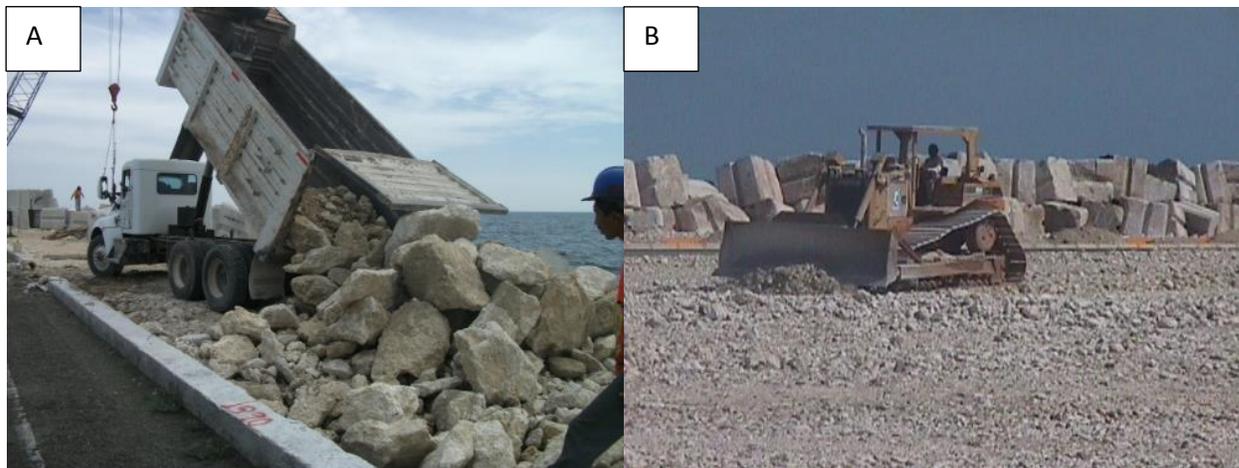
A) Ejemplo de acarreo y llegada de la piedra a la zona de trabajo y B) Se visualiza el tractor sobre orugas empujando la piedra hacia el frente del bordo.
